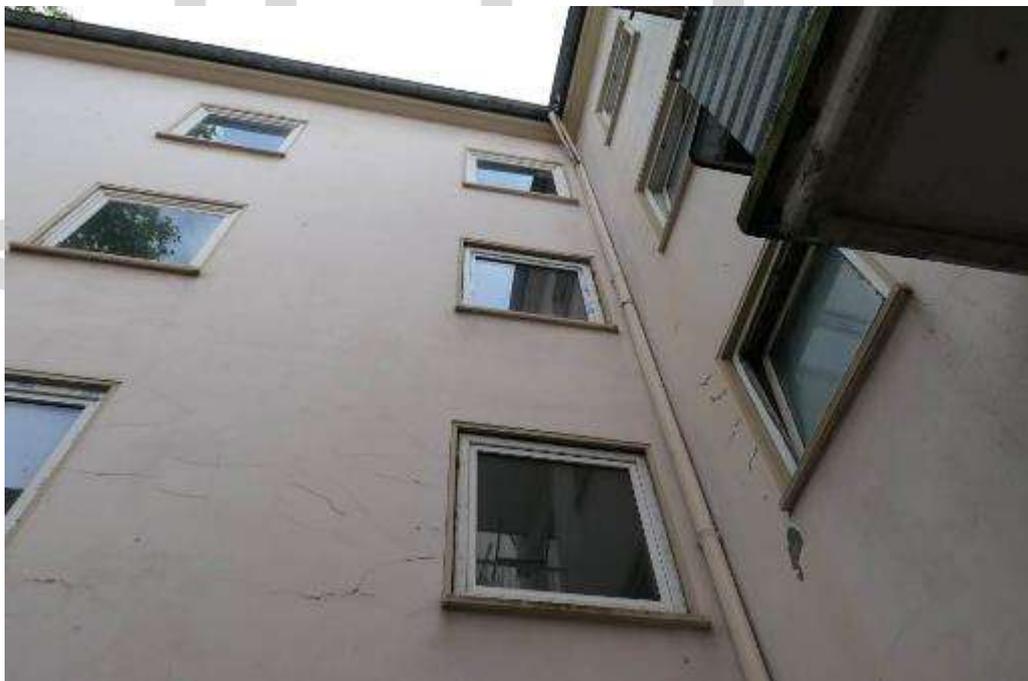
rückseitige Fassade mit Sanierungsbedarf
